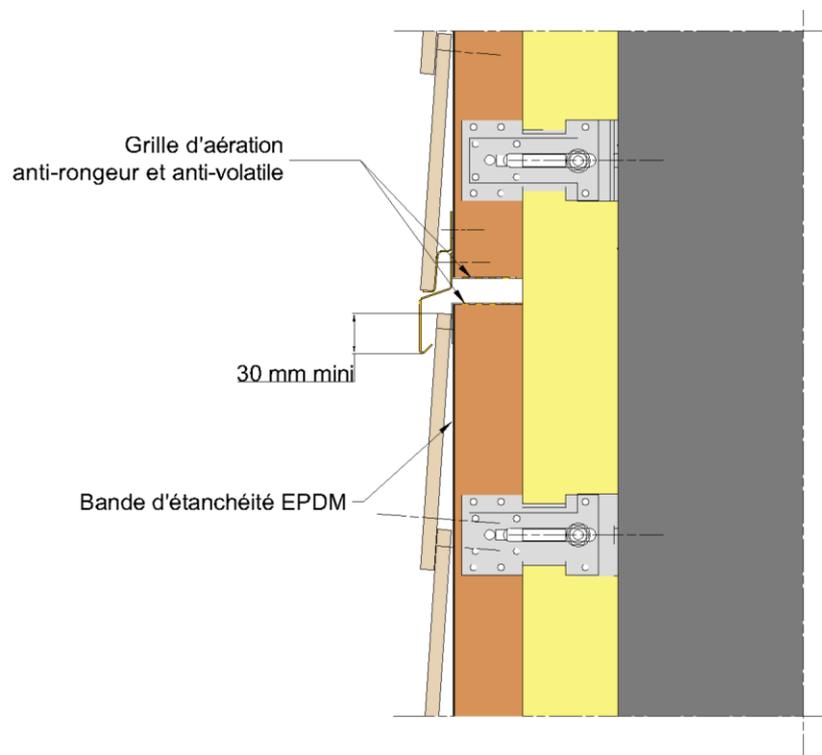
Fractionnement de l'ossature – pose horizontale des lames CEDRAL LAP et fixation en rive haute et basse (compris entre 5,40 m et 12 m de hauteur maximum)
